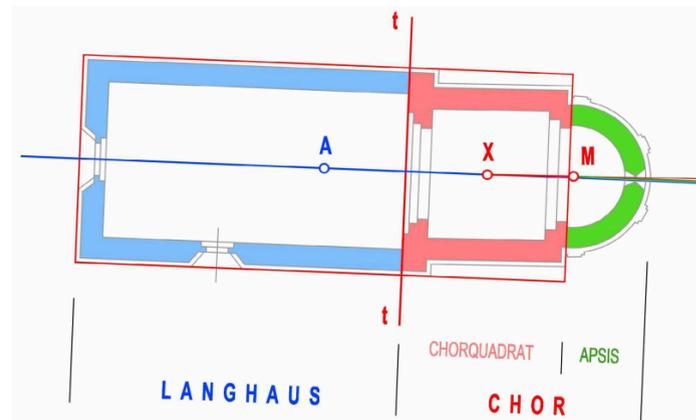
Pfarrkirche Schöngrabern, Grundriss der dreiteiligen Anlage mit Gliederung: Langhaus, Chorquadrat und Apsis.
